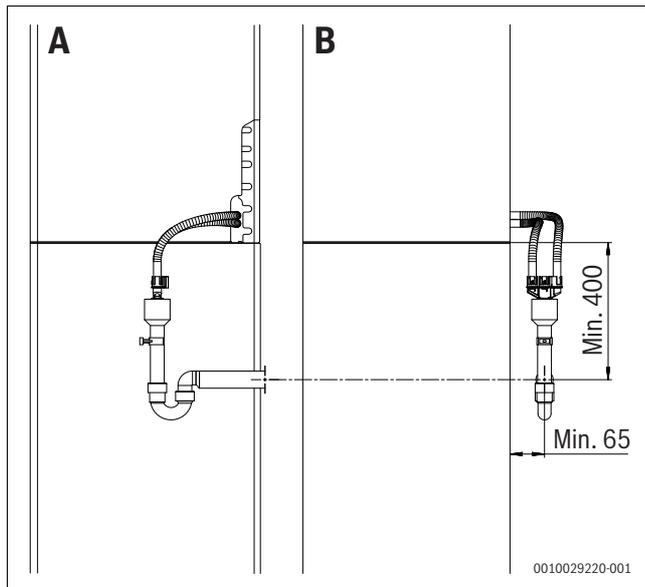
A : vue côté droit (dimensions en mm)
